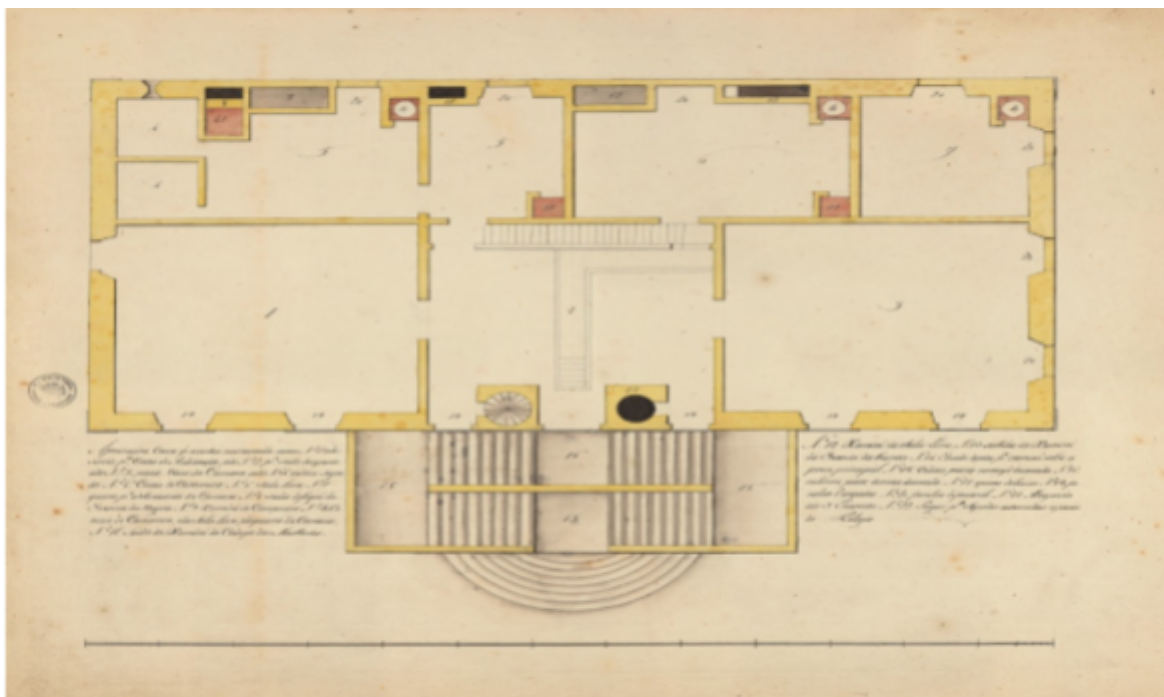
Planta B da Casa de Câmara e Cadeia de Mariana.
